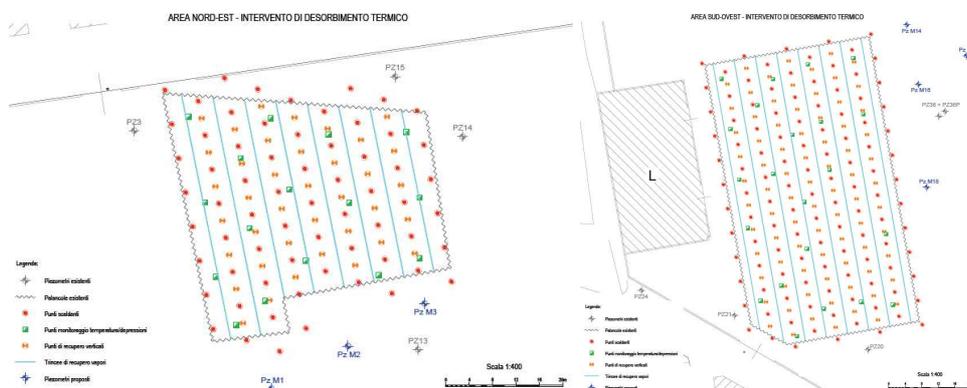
Posizione delle installazioni previste nelle due aree di sorgente, layout camp pozzi
